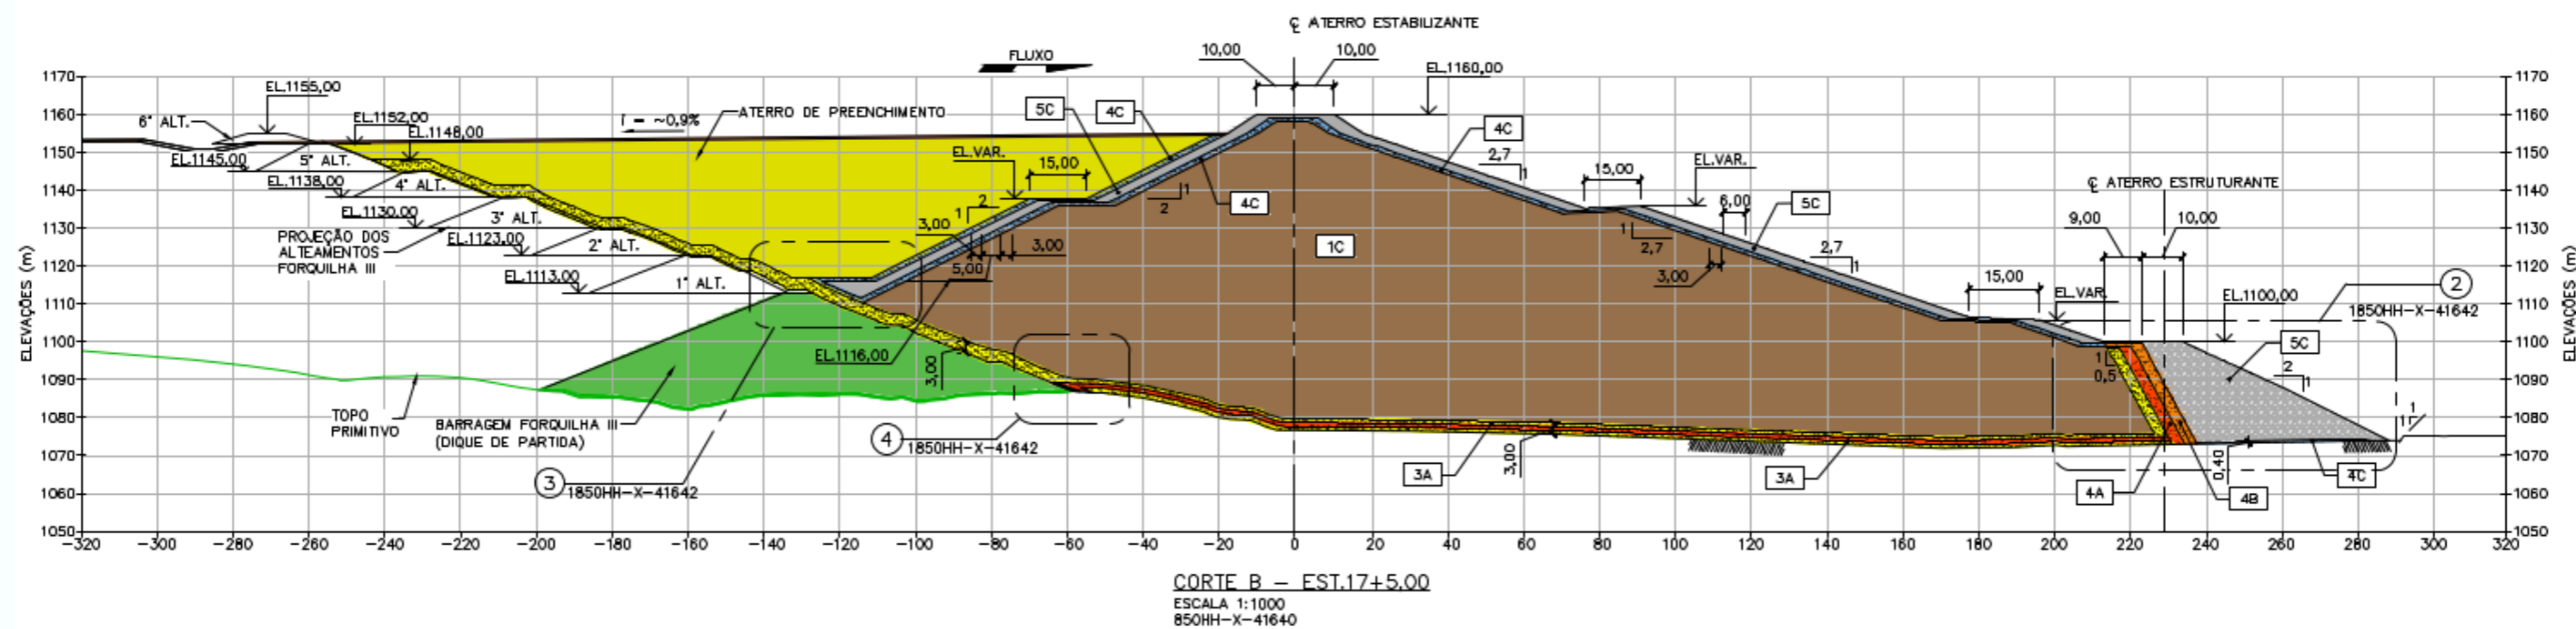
Aterro de descaracterização, projeto detalhado 1850HH-X-41641-Rev02 (Fonte: Intertechne, 2025).
